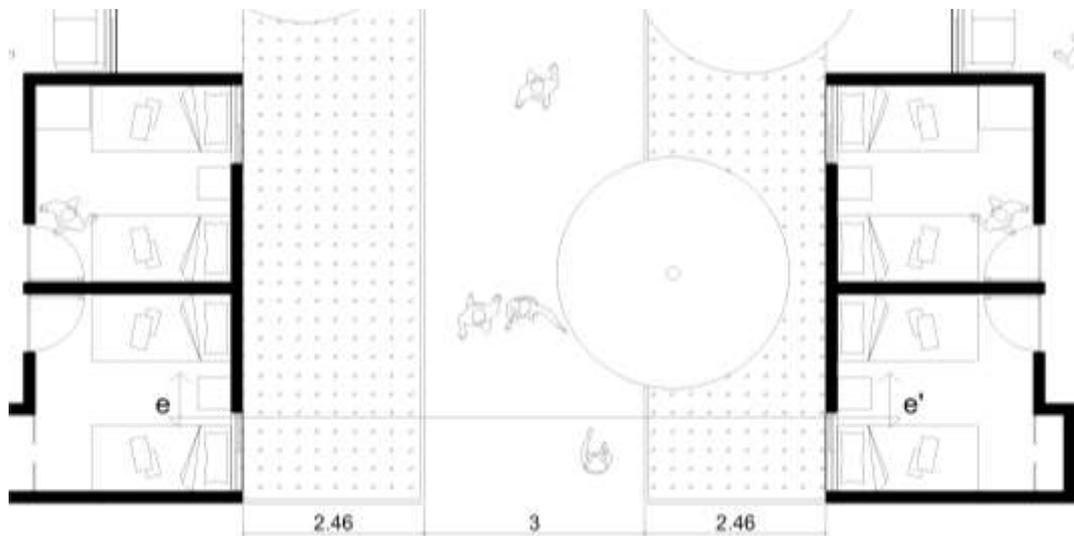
Planta arquitectónica de la propuesta, en la cual se sugiere un andador de 3 metros al centro y jardineras de 2.46 metros adosadas a los muros de los departamentos que, además sirven de espacio de transición entre lo público y lo privado.
